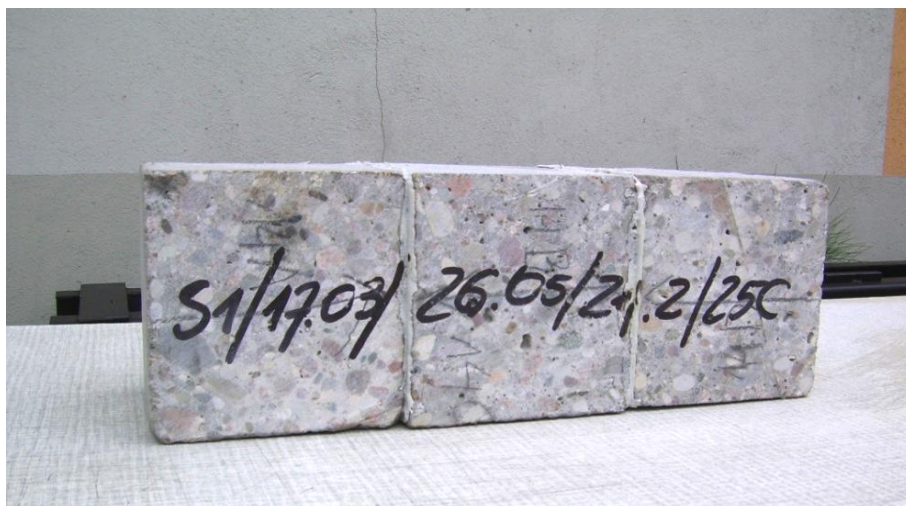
a) Widok próbek do badania przyczepności w warunkach odrywania kleju epoksydowego i taśm CFRP od betonu
